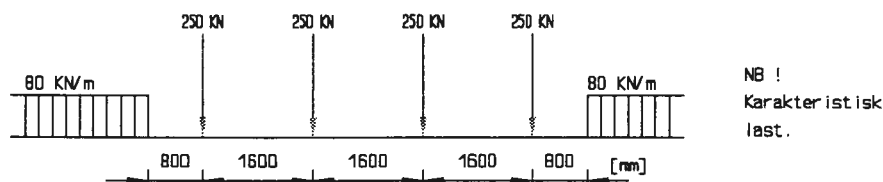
Dimensjonerende laster ved dobbeltspor.
